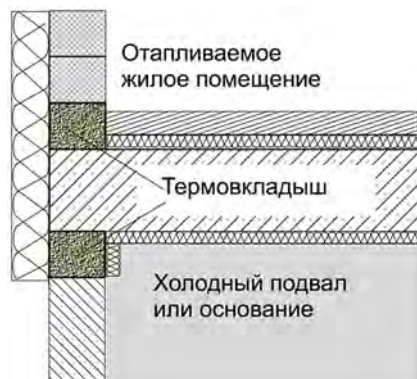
Ликвидация «теплого мостика» в месте стыка наружной стены с подвальным перекрытием и подвальной стеной или с плитой основания и фундаментной стеной за счет установки термовкладыша
